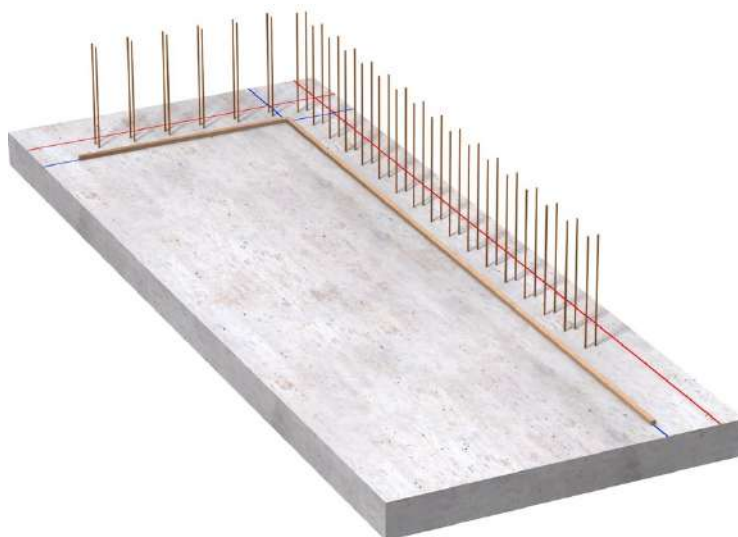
Reglas de madera sobre la línea interior de replanteo del muro
